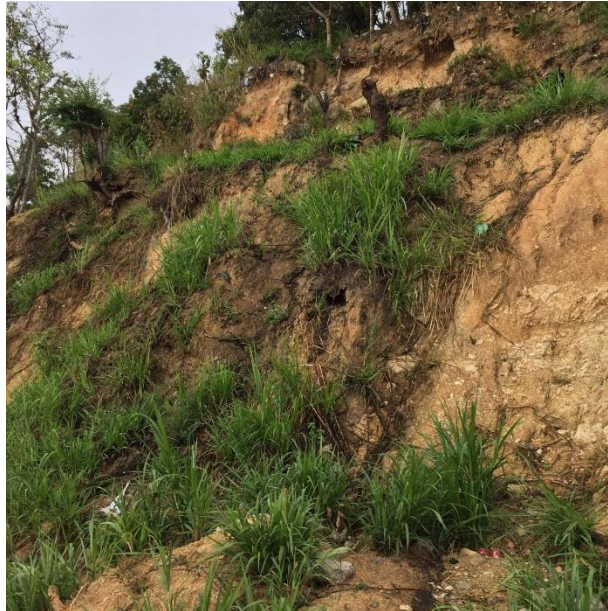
Fallas en vivienda deslizamiento de tierra
